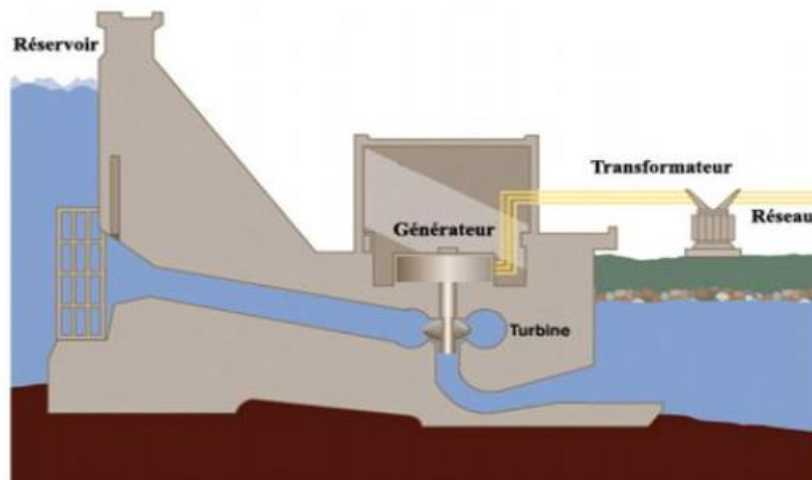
Schéma en coupe d'un barrage hydroélectrique.
